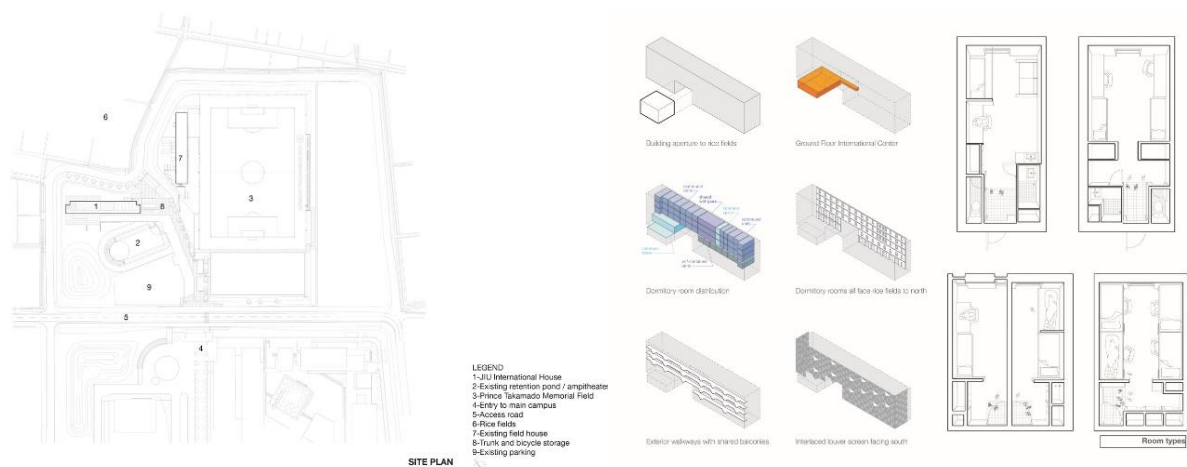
iHouse Dormitory. Генеральний план і варіанти кімнат [25]
